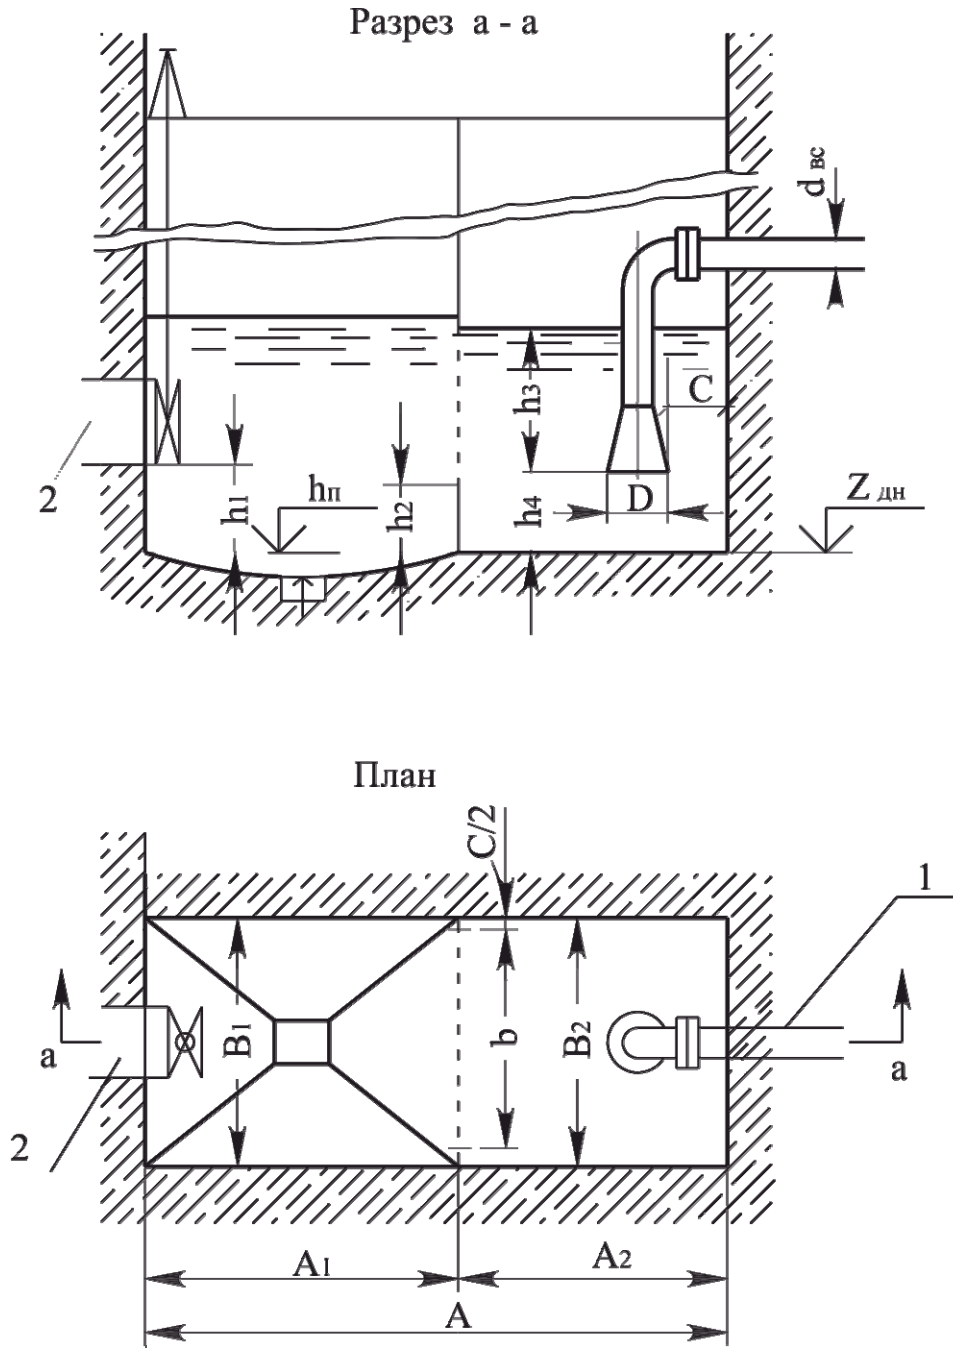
Схема к определению размеров водоприемной камеры: 1 — всасывающий трубопровод; 2 — самотечный водовод
